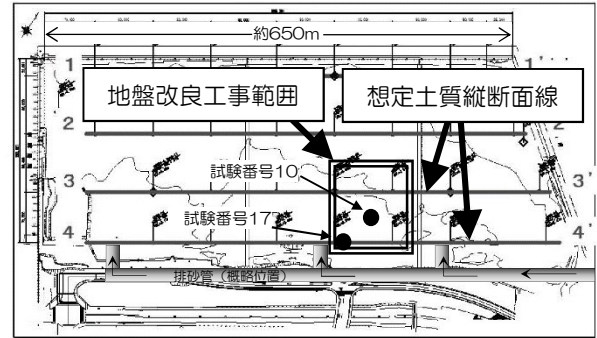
地盤改良工事範囲と想定土質縦断面図位置平面図
